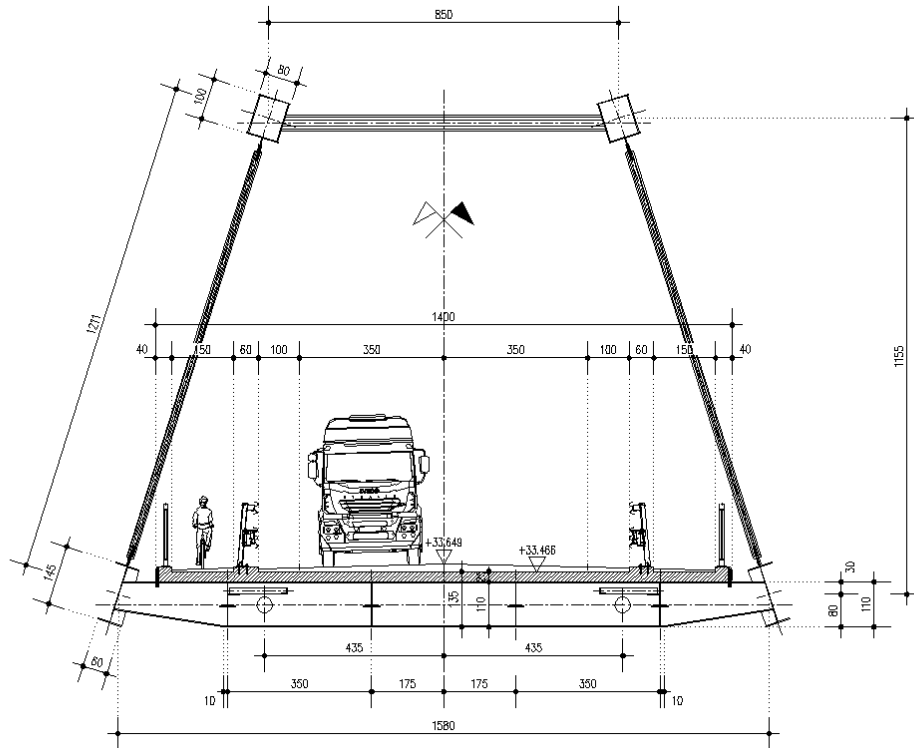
Impalcato- Sezione trasversale in mezzeria
